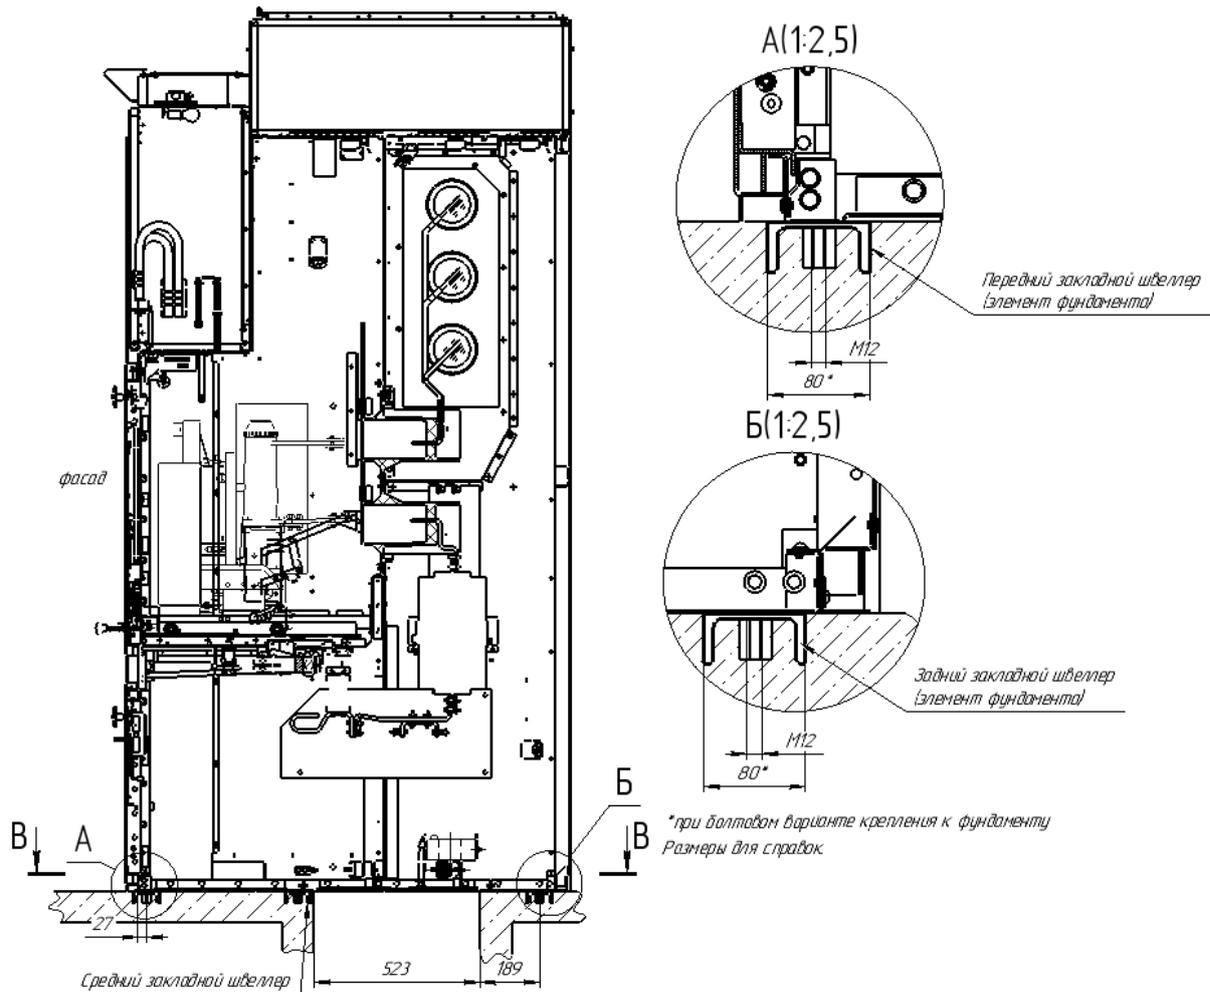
Установка СЭЩ-80-10С на фундамент с кабельным каналом
